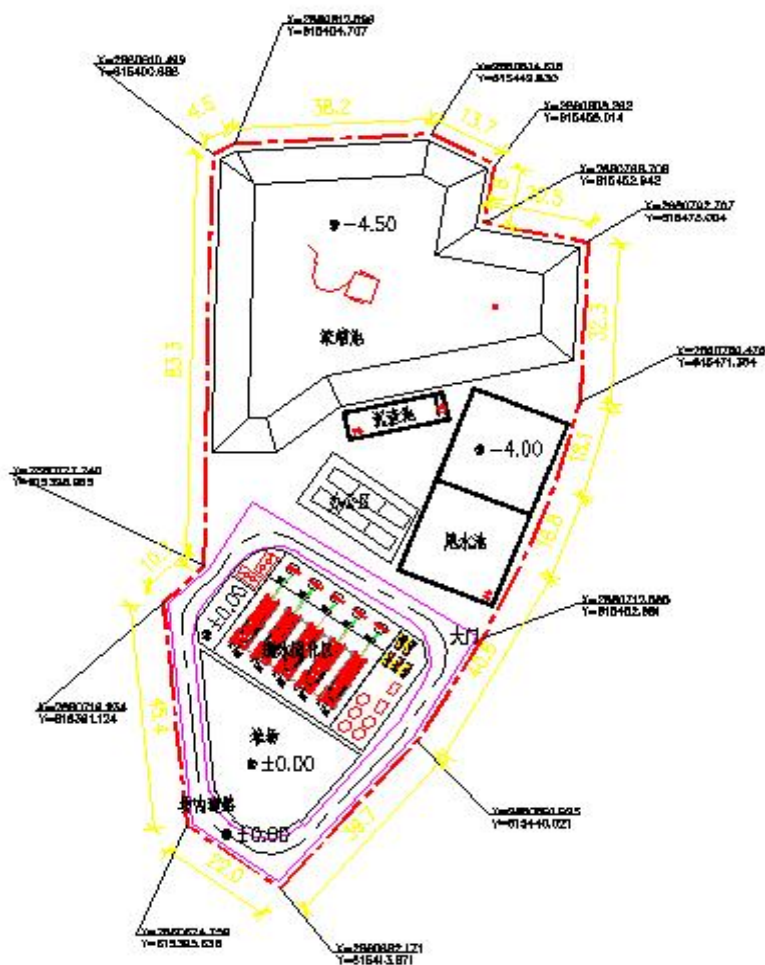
喜洲镇江上村淤泥固化场平面布置图
